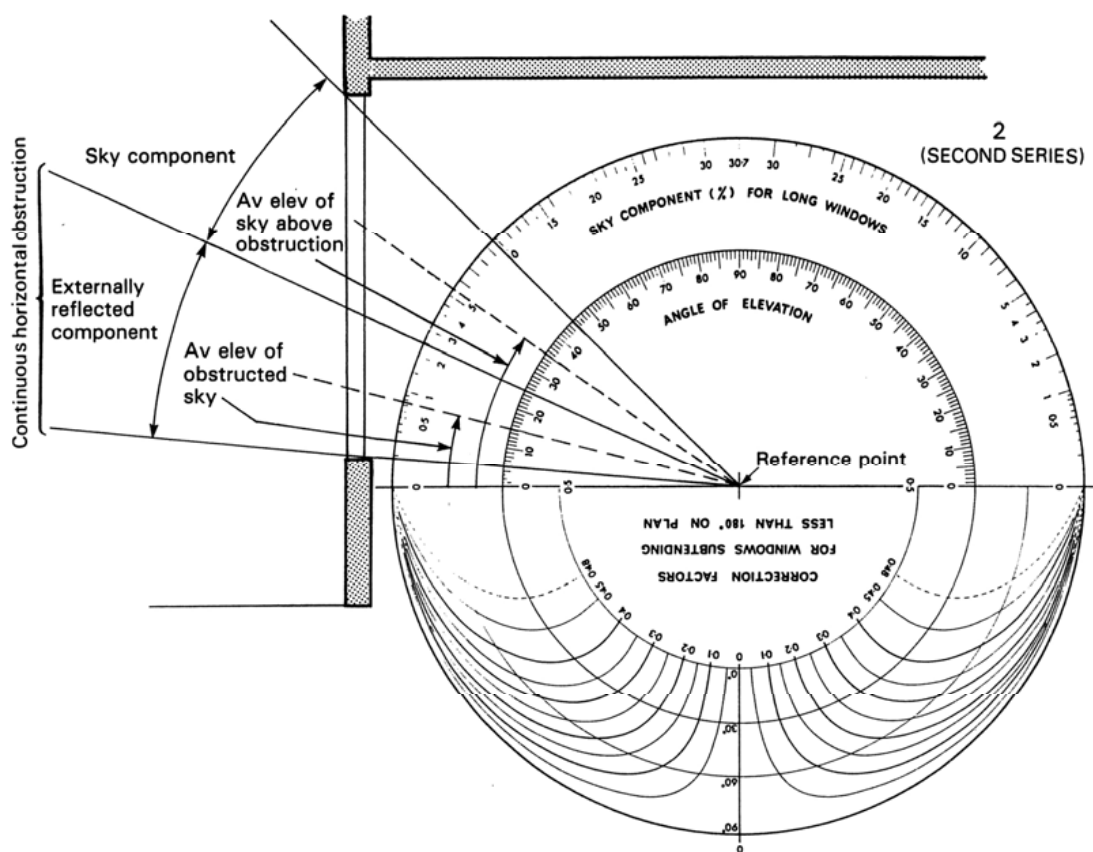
Schéma de principe – coupe verticale (Source : BRE Digest 309)
